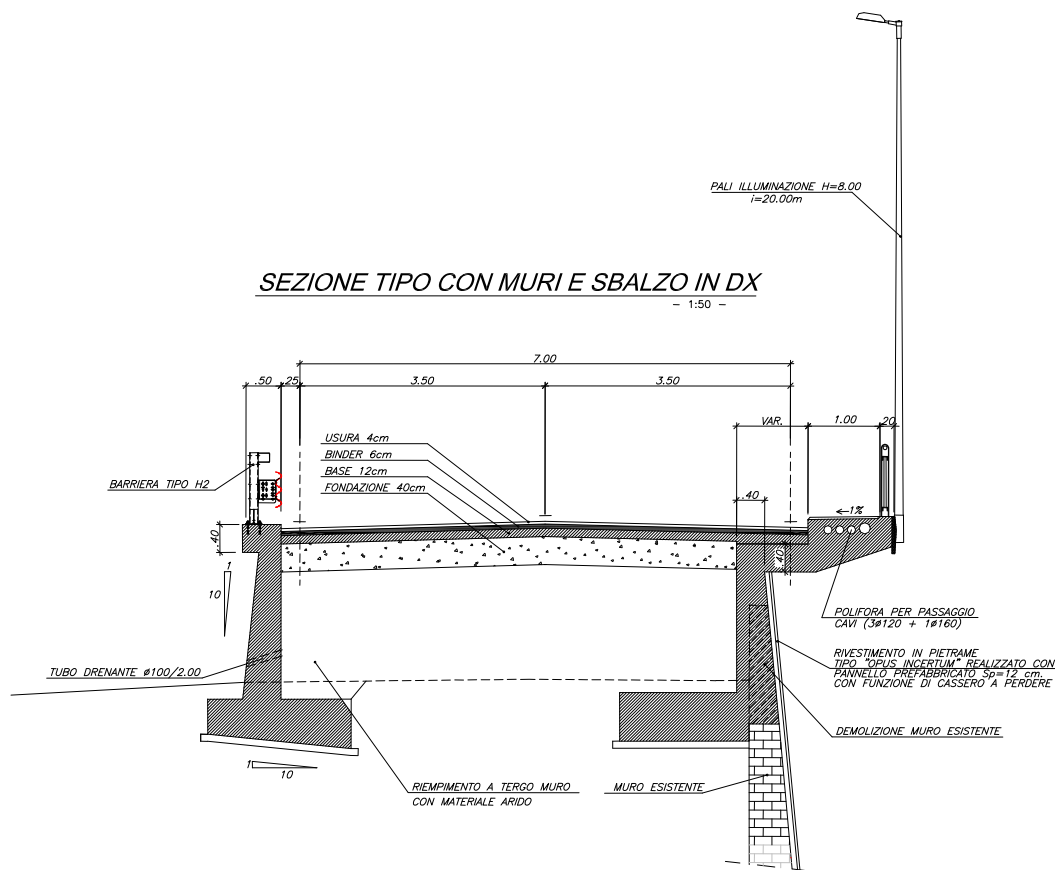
Sezione tipo con muro ed opera a sbalzo.
